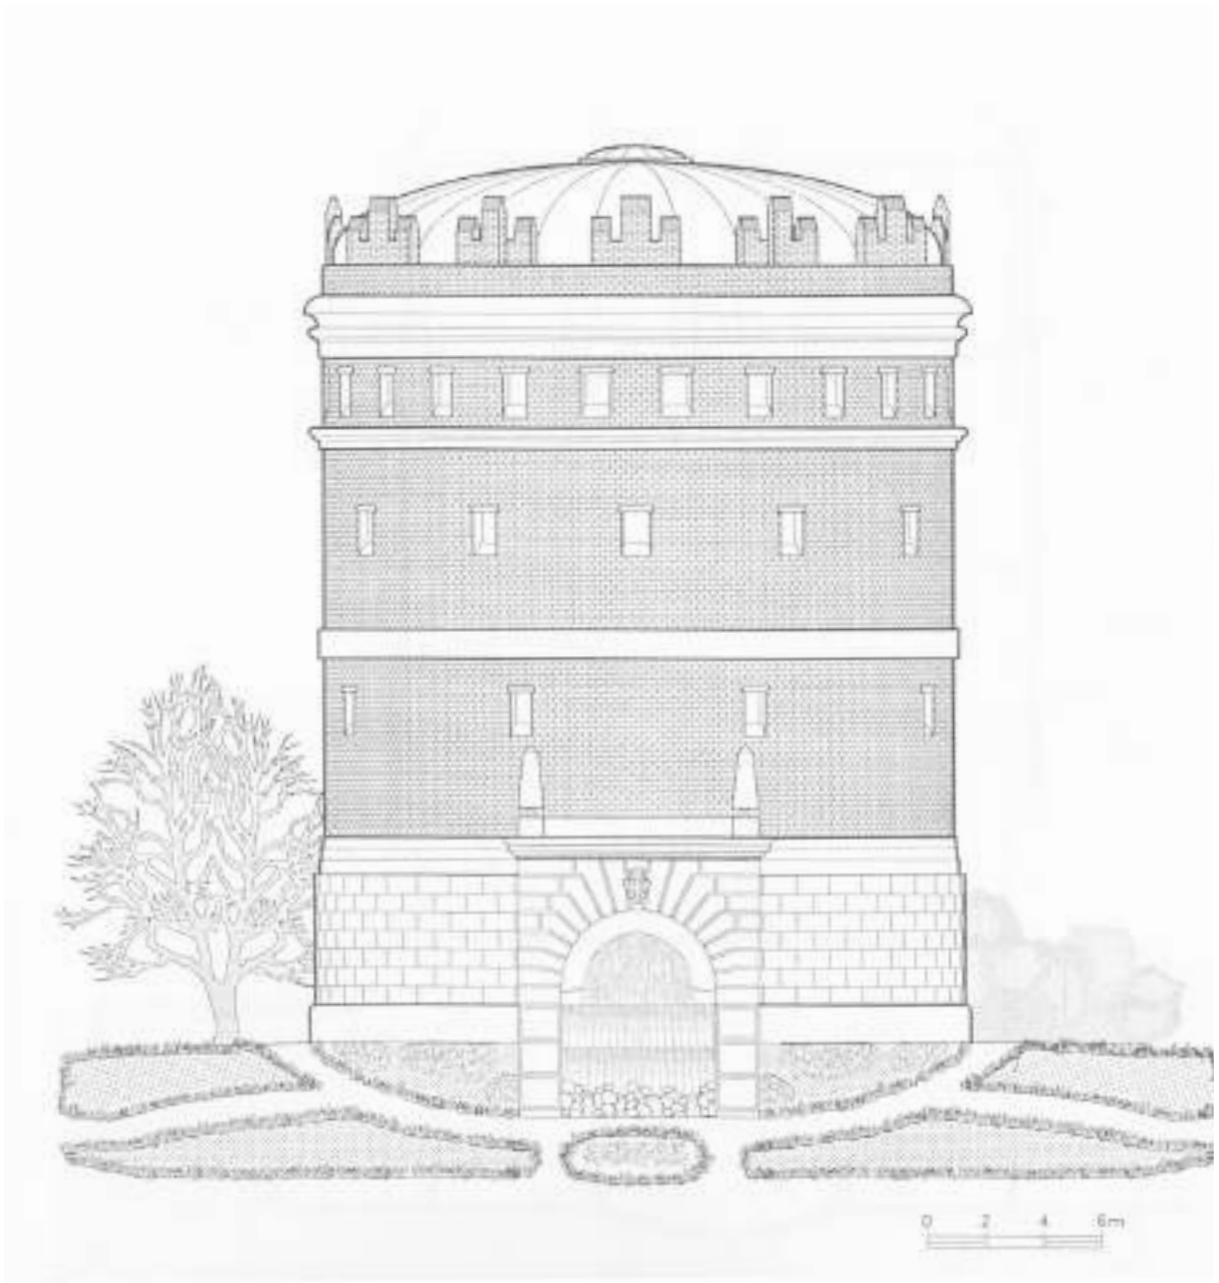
Serbatoio La Rotonda dell'acquedotto di Padova, prospetto di progetto.
